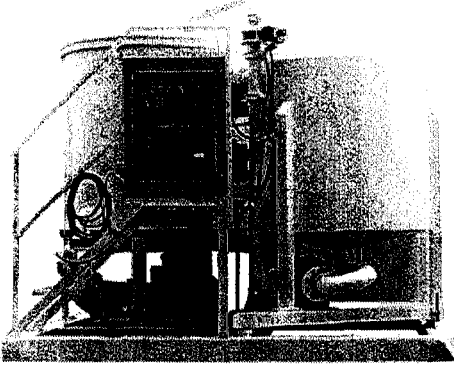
Jet Grout yönteminde kullanılan ekipmanlar
